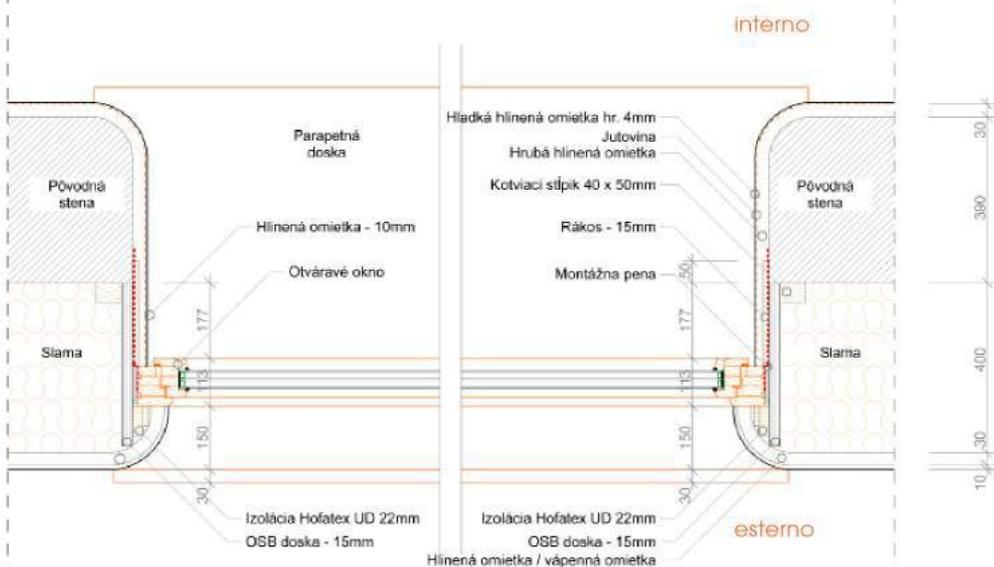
DETAIL ZATEPLENIA SLAMENÝMI BALÍMKI, BRESTOVEC, SLOVENSKO, 1:20
